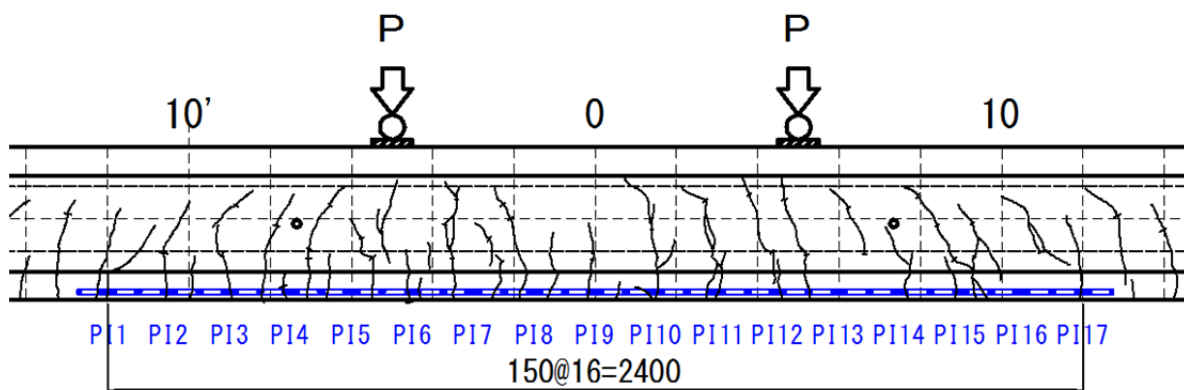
96.9kN 載荷時 桁側面ひび割れ図
